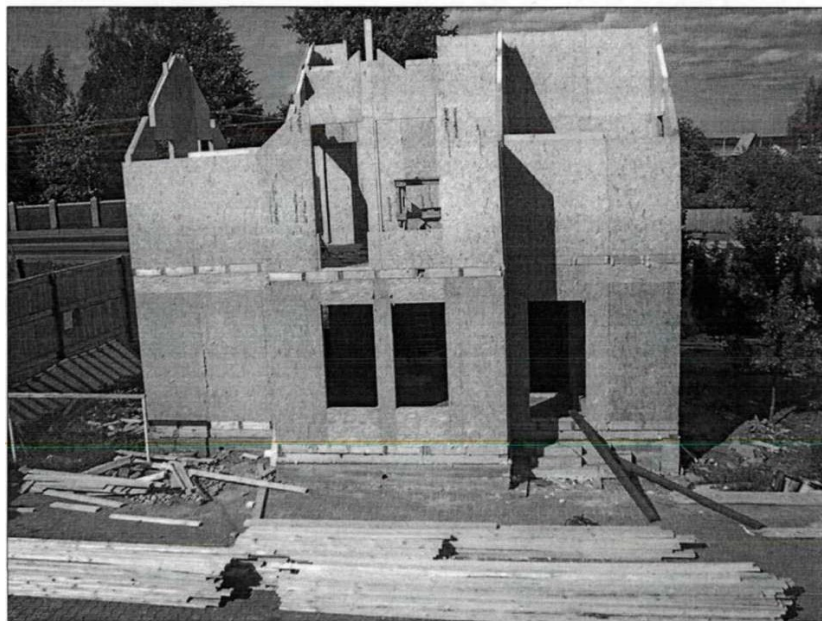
Влаштування каркаса і стін горищного простору з сендвіч-панелей
